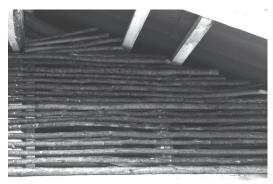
SOPORTE DE TIRILLAS REALIZADO PARA EL ENSAYO, FUENTE: AUTOR
